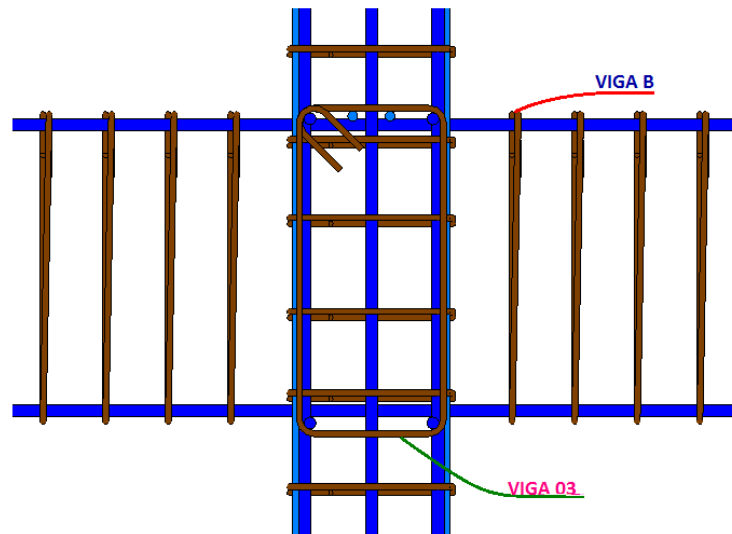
Propuestas de detalle del refuerzo en conexión viga – columna
